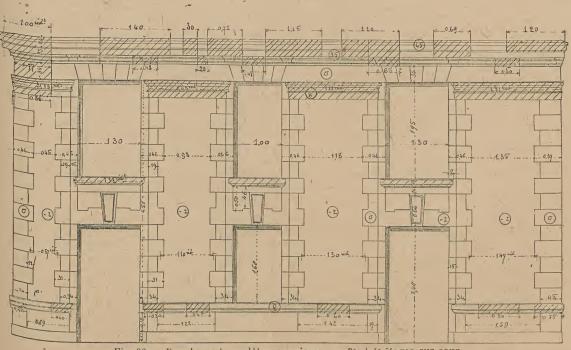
Ravalement en platre sur vieux mur 3° et 4° étages sur cour. Plan du ravalement et élévation.
